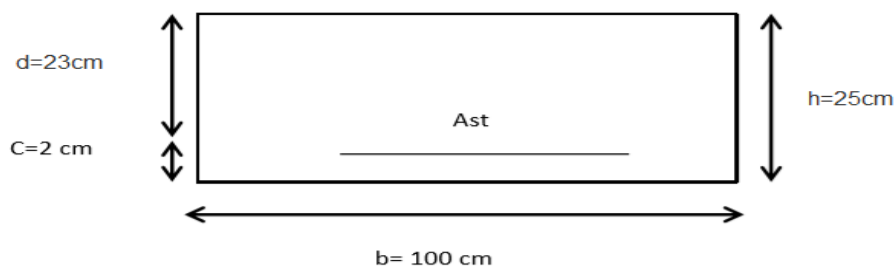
Schéma statique de ferrailage du mur plaque.
